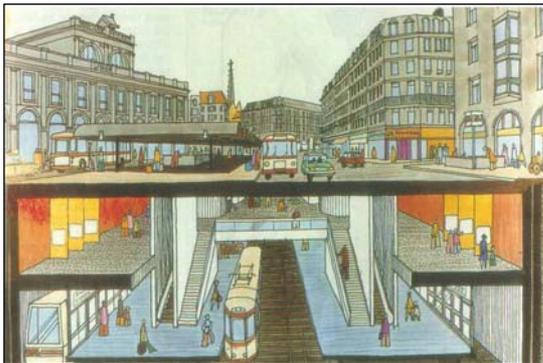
Transportes urbanos en la estación Lille Flandres: metro en la planta -2, tranvía en la -1 y autobuses y ferrocarril en la planta baja.
